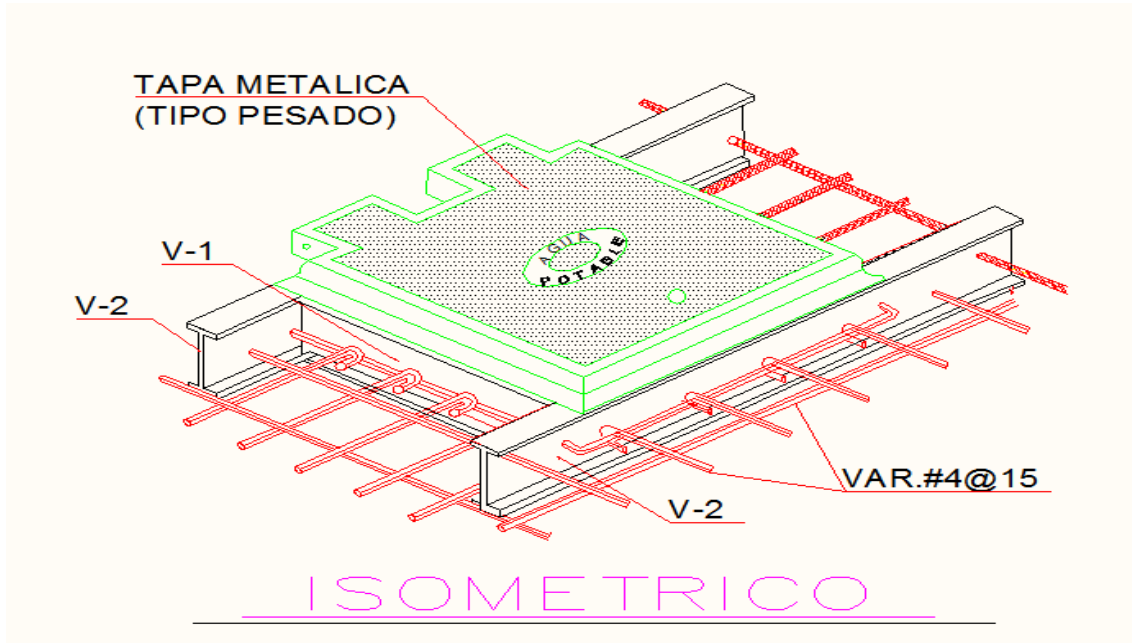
DETALLE DE ARMADO DE LA CAJA TIPO 1-1-A
